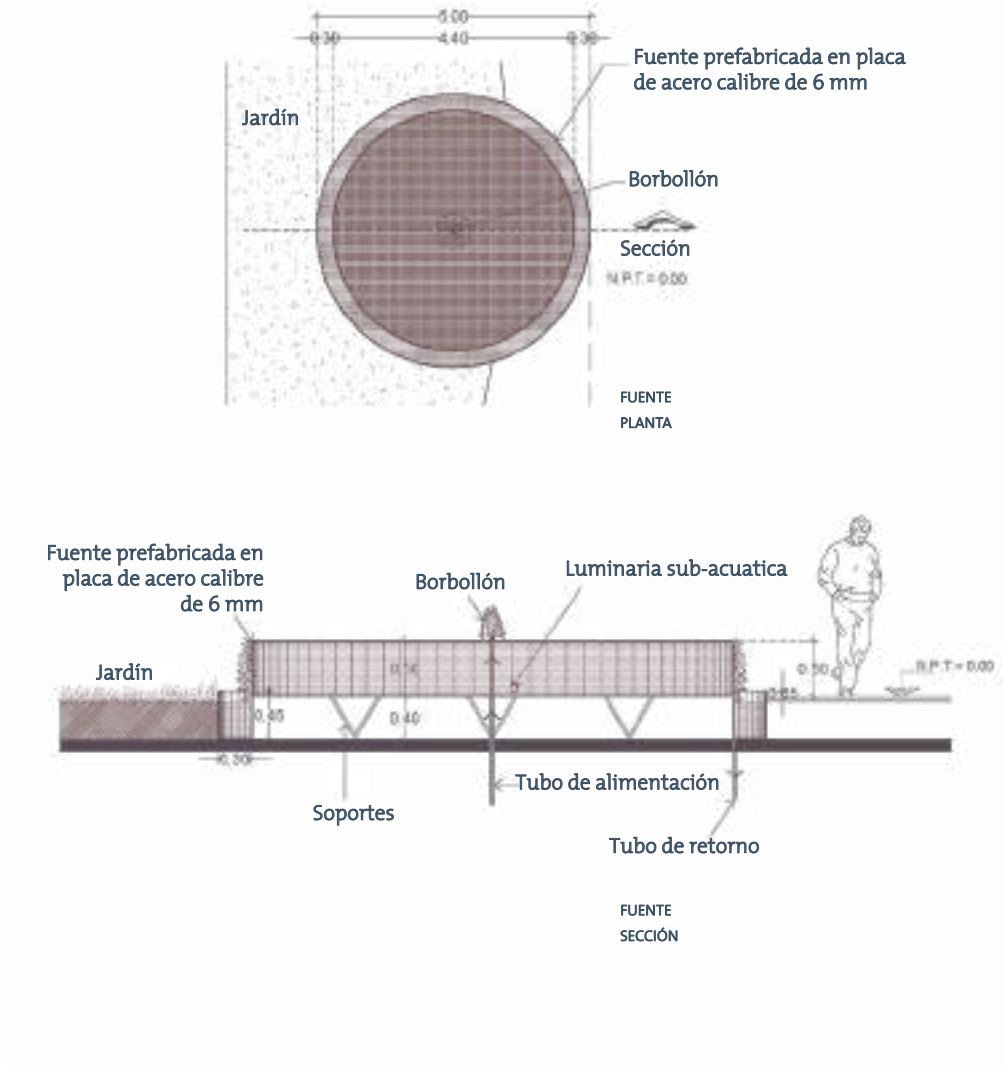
Detalle de fuente fabricada con placa de acero, en una plaza sobre la estructura de un estacionamiento
